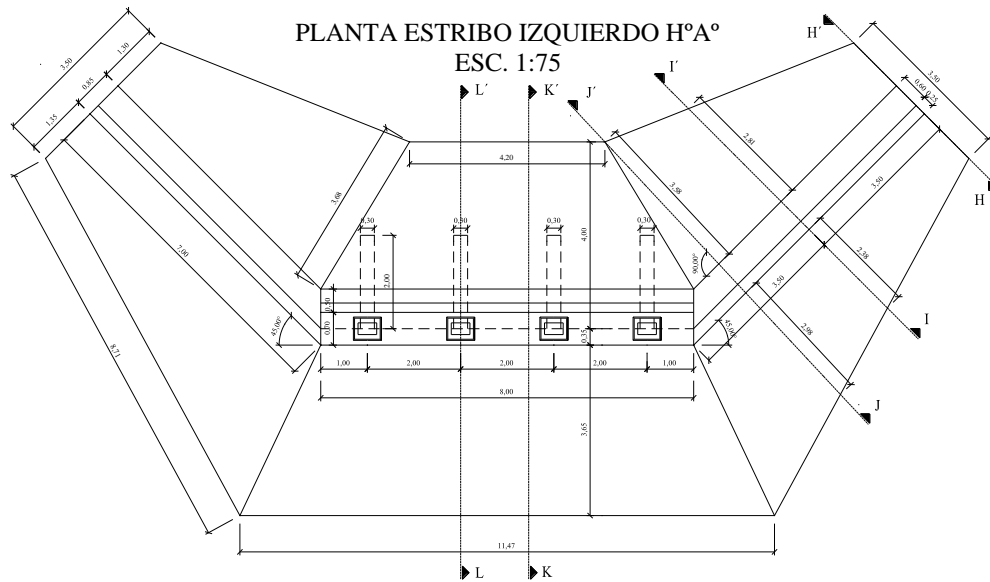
Vista en Planta del Estribo Tipo:
